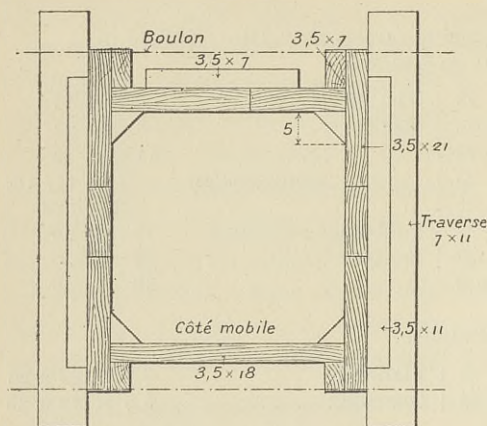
Coupe d'un coffrage de poteau de section carrée.
